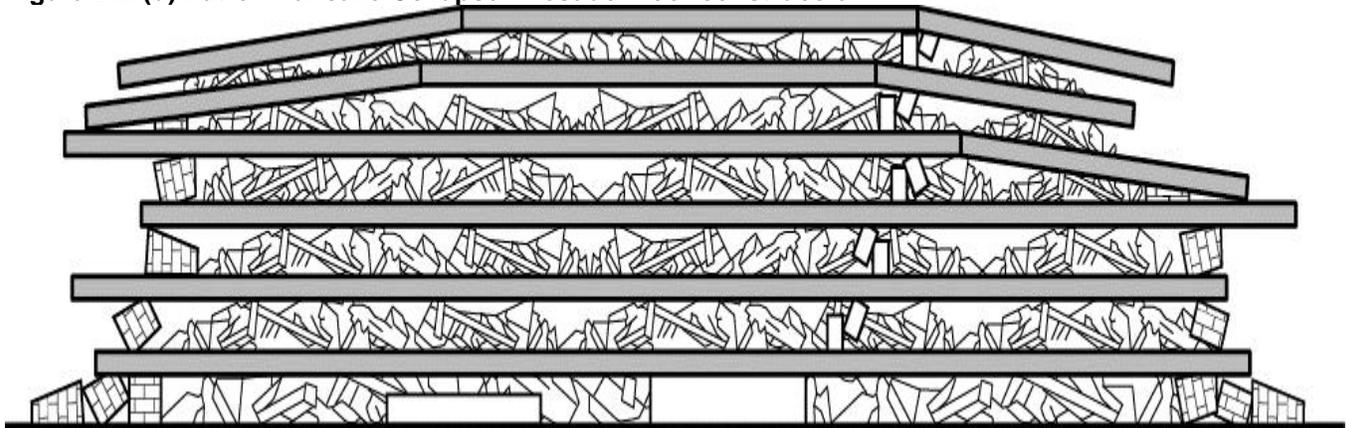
(e) Revocar Pattern Collapse - Floor pesado o de acero pesado de construcción.
